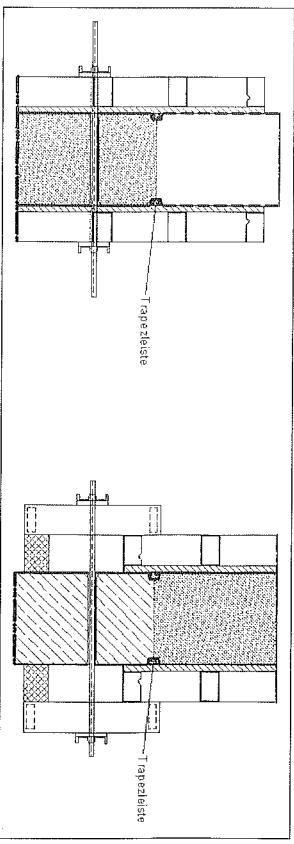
Arbeitsfuge mit Trapezleiste; links: erster Betonierabschnitt; rechts: zweiter Betonierabschnitt
